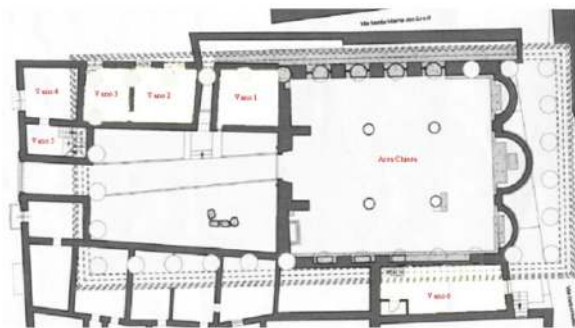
Planimetria della chiesa e dei locali annessi con indicazione dei vani interessati dalle operazioni di scavo archeologico e con sovrapposizione indicazione ubicazione tempio greco. Planimetria de G. Sanzo e G. Sajeve (Studio Sanzo-Sajeve).
